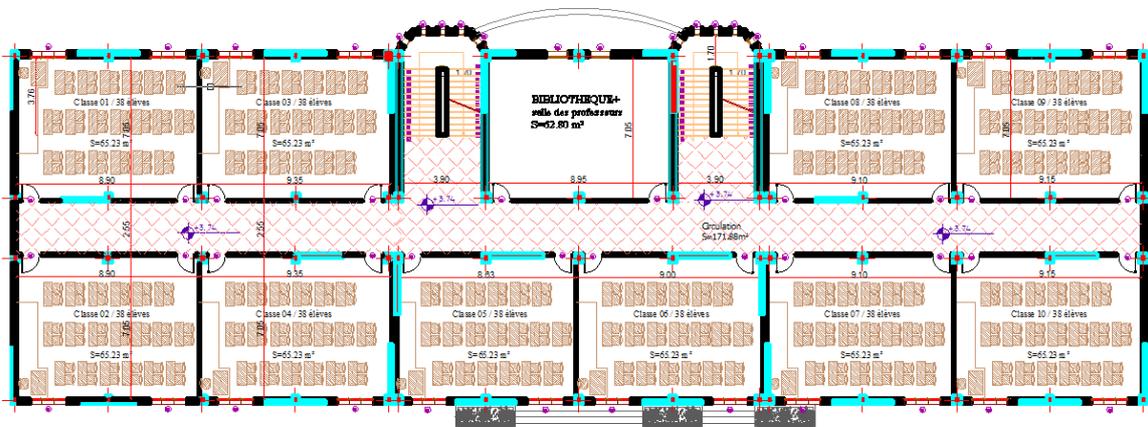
plan du 1<sup>er</sup> étage (source SARL ICARA)
